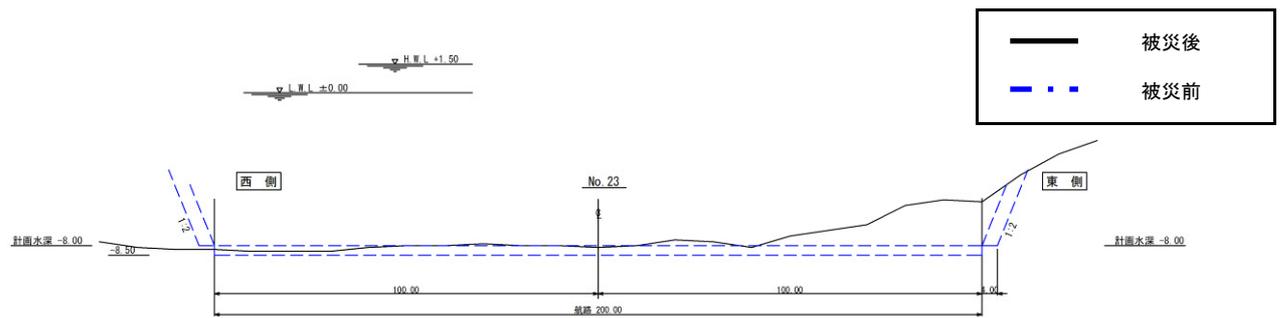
No.1 大洗港区_中央地区航路 (-8m) の断面図 (被災後)
